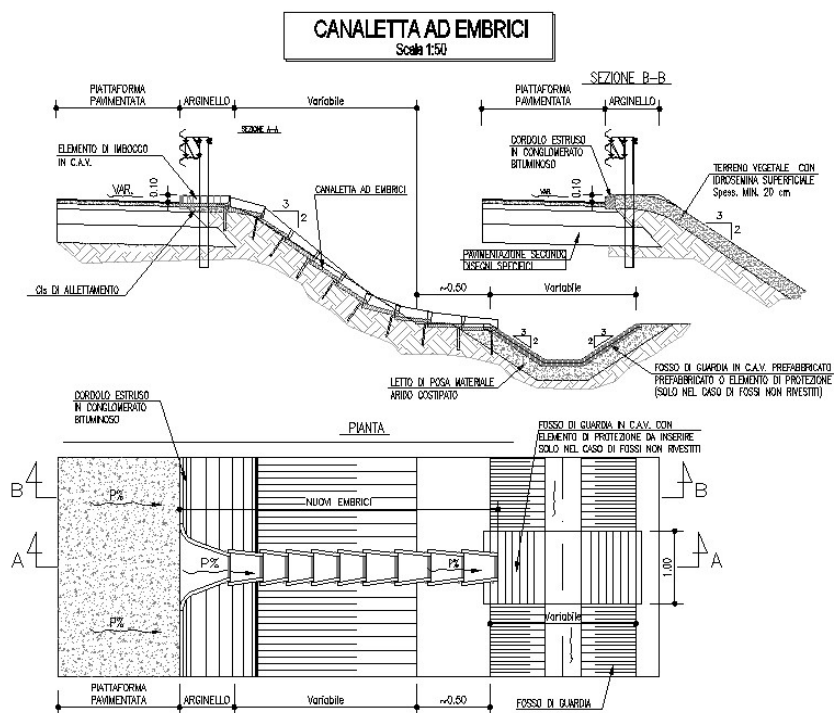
Pianta vista e sezione tipologia scarico con embrici
